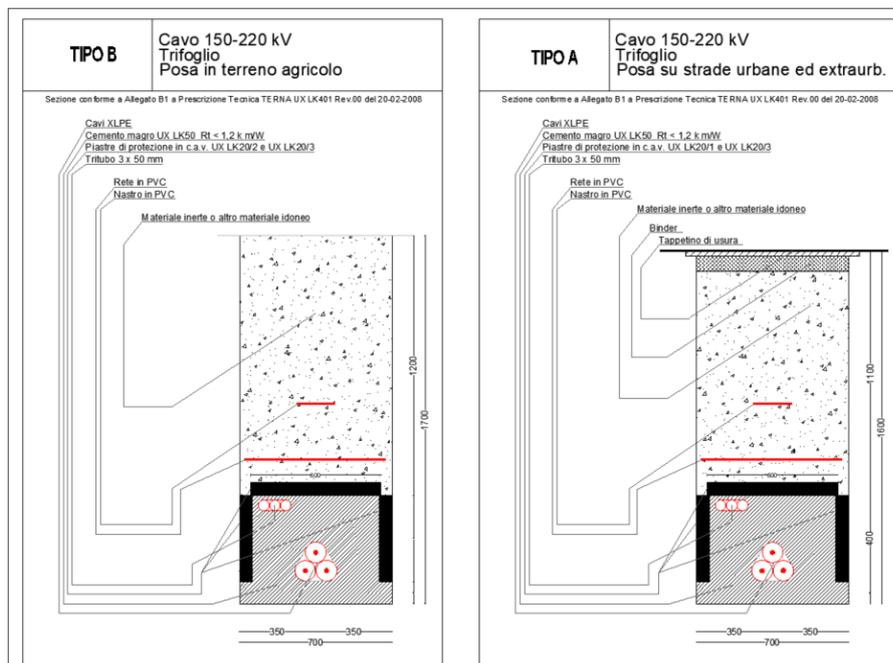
Sezione di posa cavidotto AT su strada asfaltata
